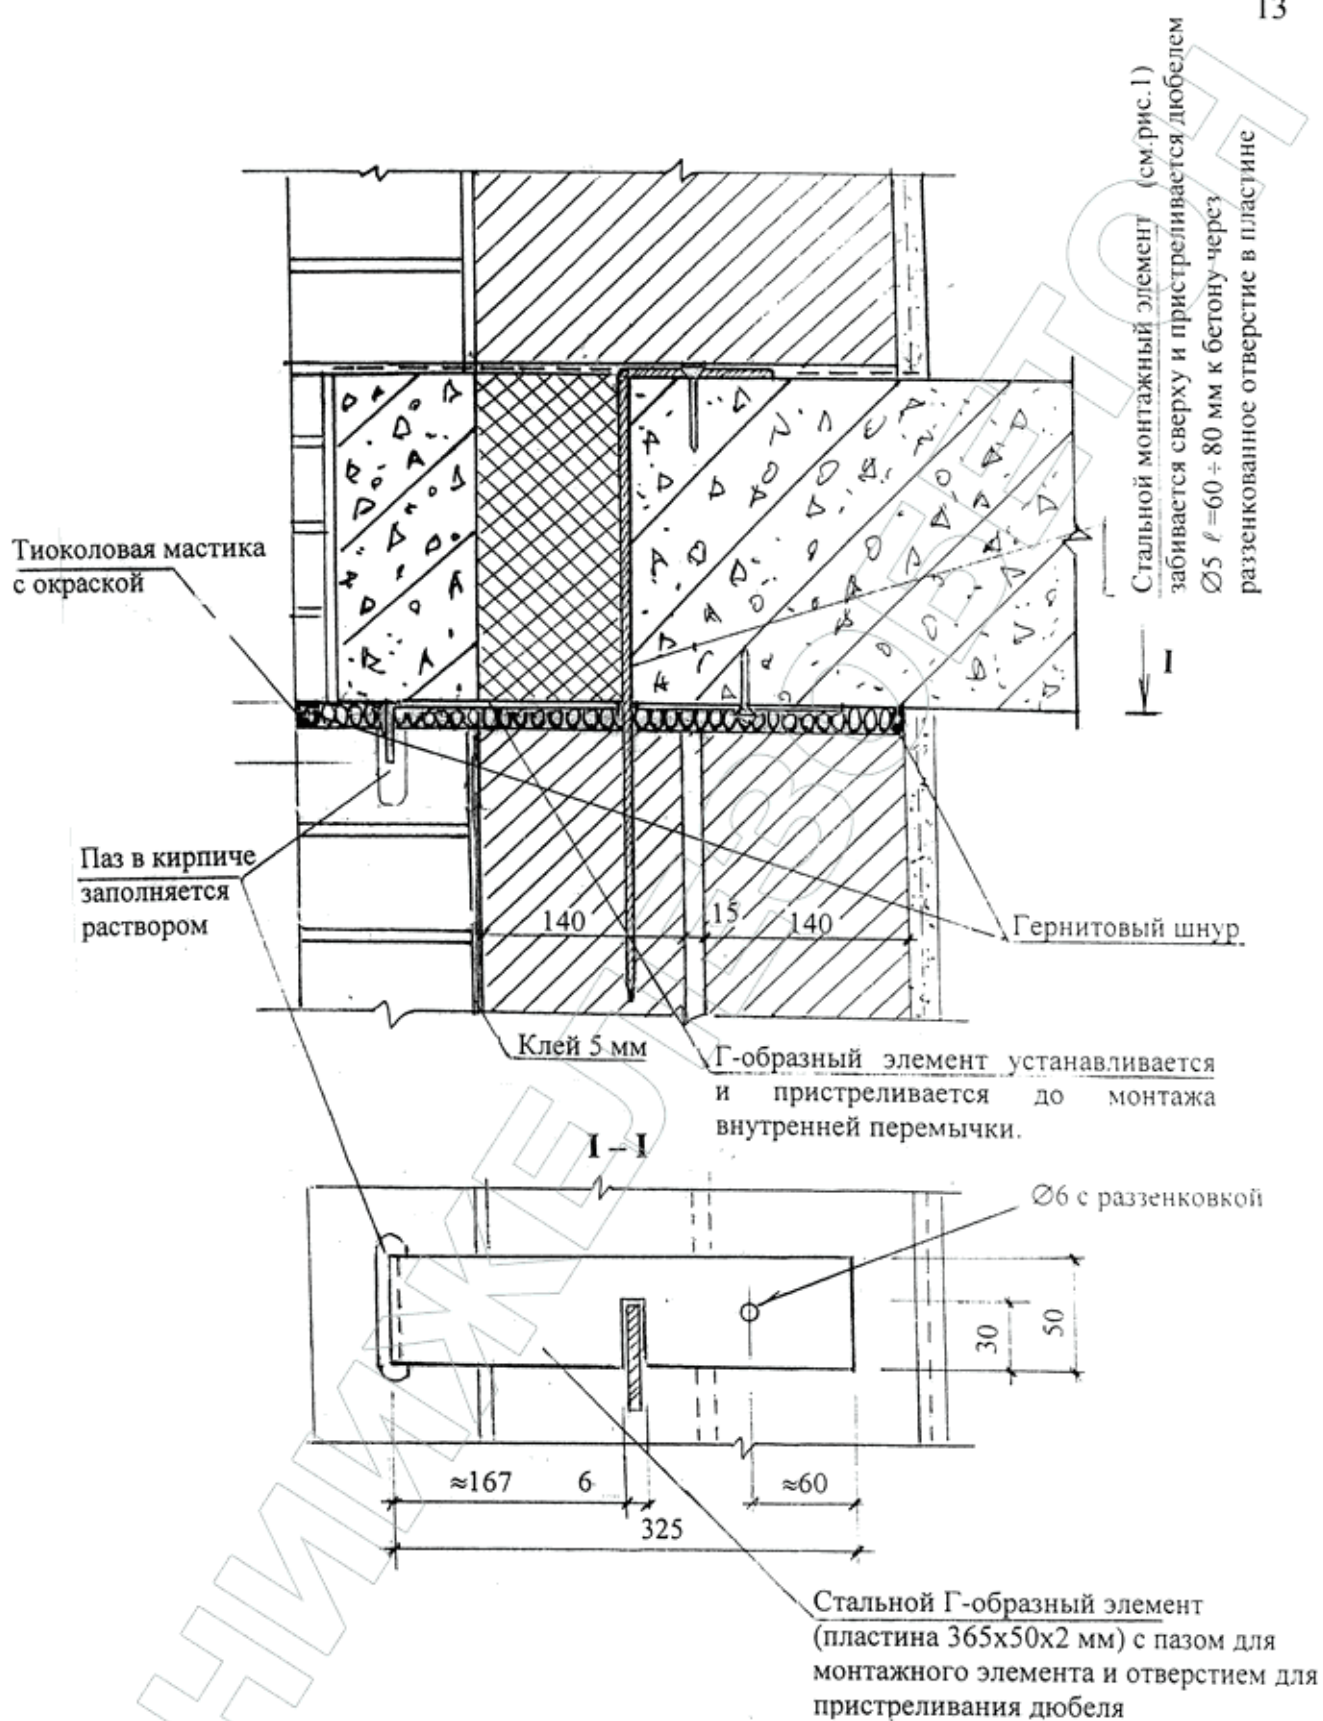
Крепление перемычек к железобетонному перекрытию на прямолинейном участке стены
